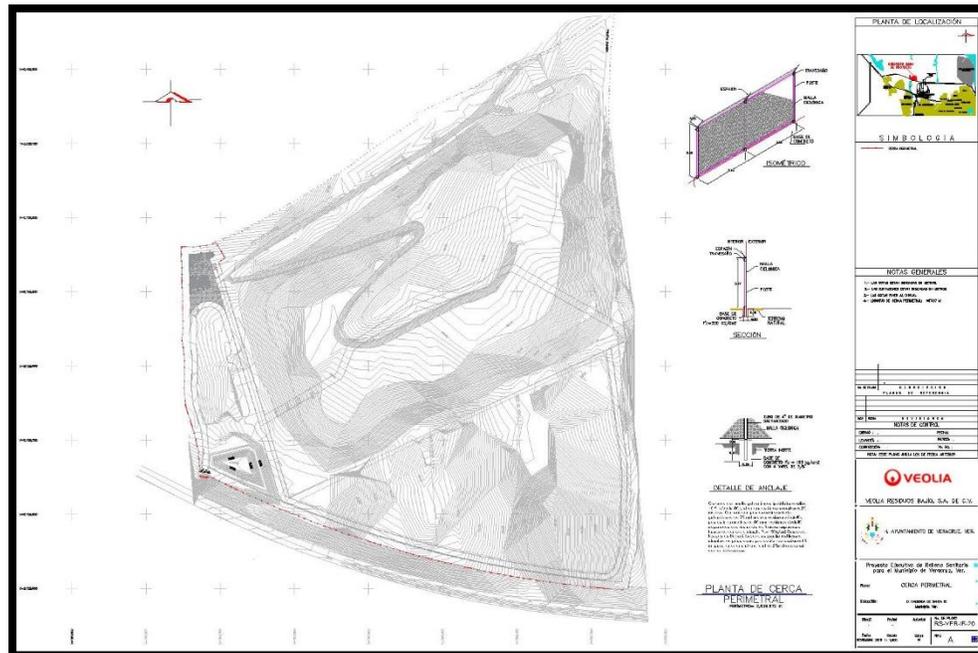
Plano sobre diseño y ubicación de cerco perimetral del proyecto.
